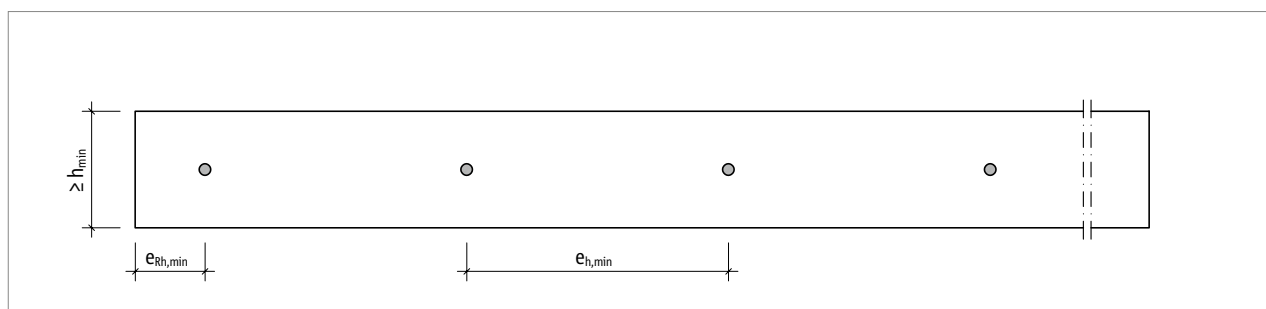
Schöck Stacon® Typ LD: Minimale Bauteilabmessungen und Dornabstände bei einer Platte
